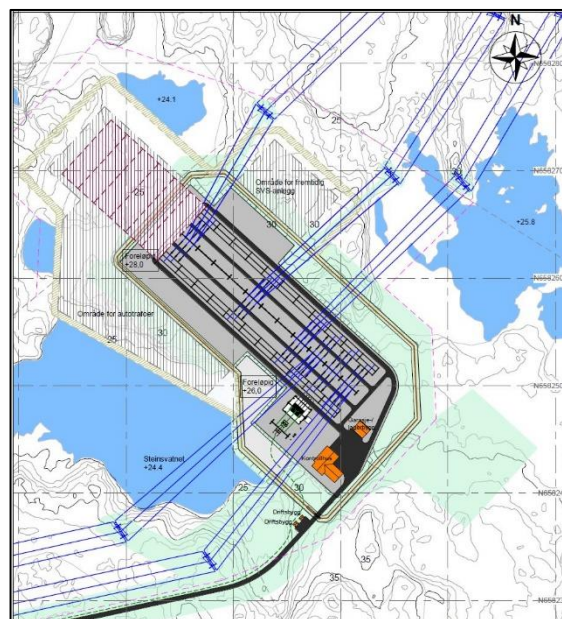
Plan for utvidelse av eksisterende Blåfalli koblingsanlegg.
